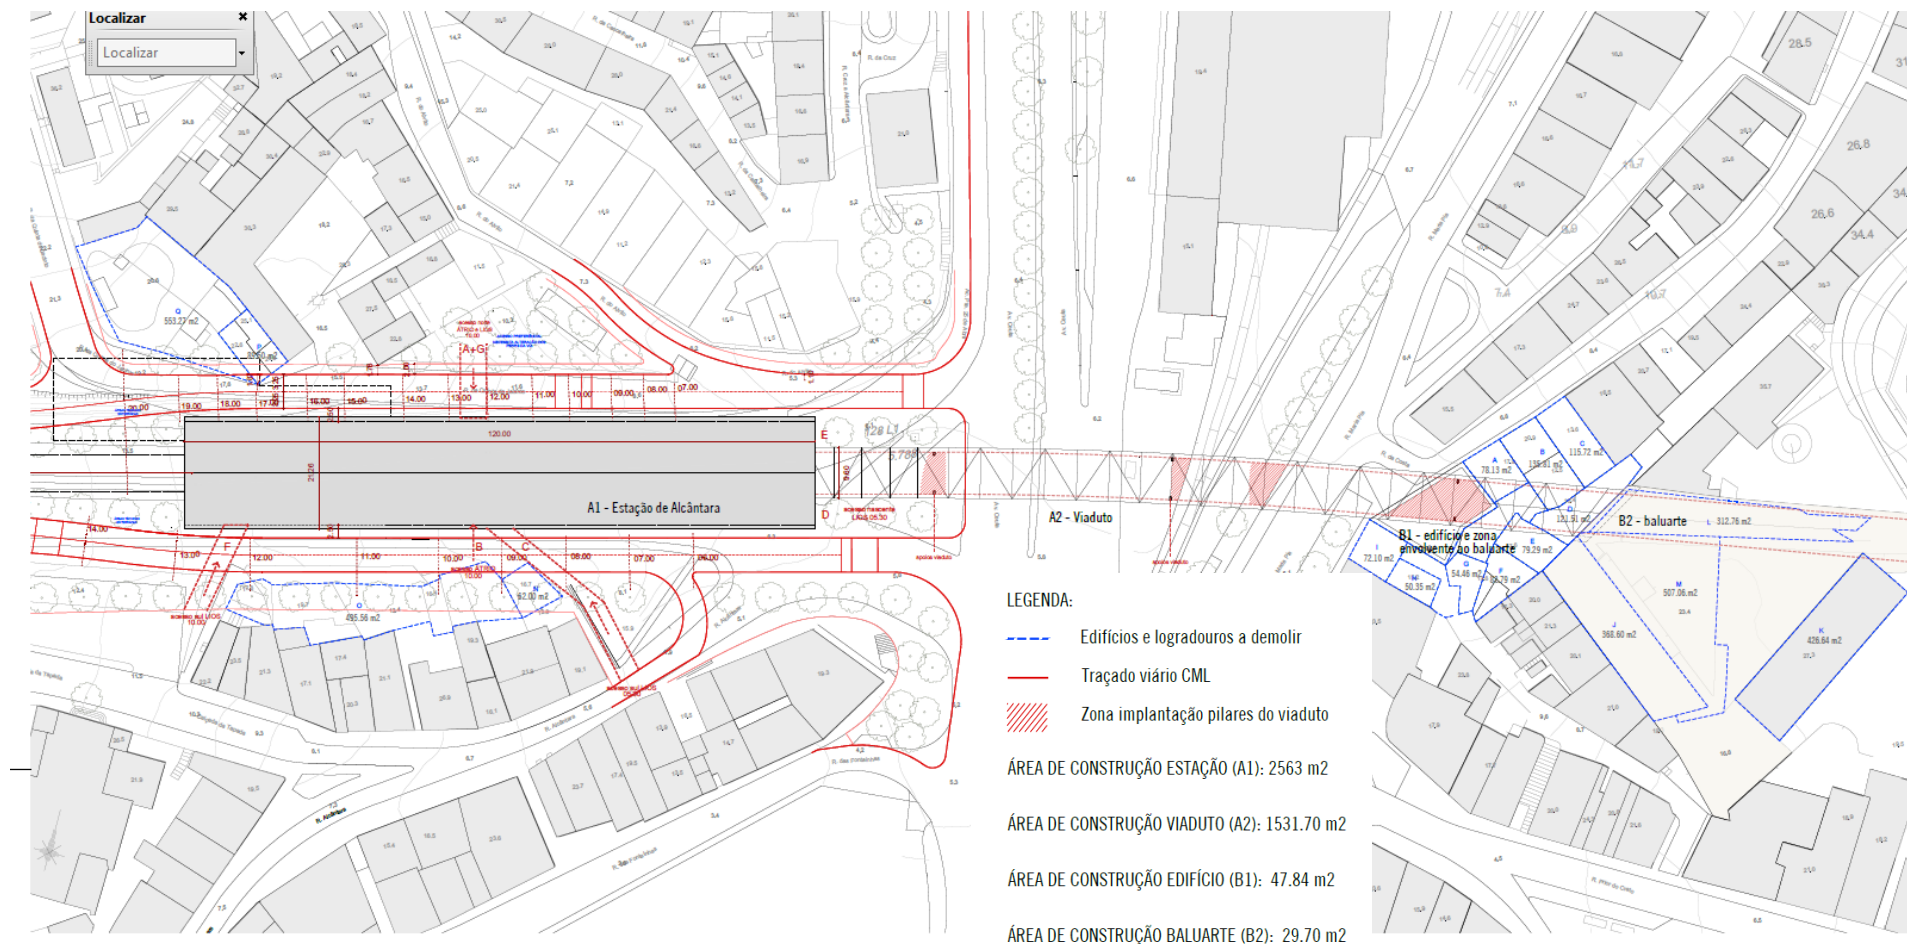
Viaduto de Acesso e Estação de Alcântara – planta de implantação. Edificações e logradouros a demolir delimitados com traço azul
